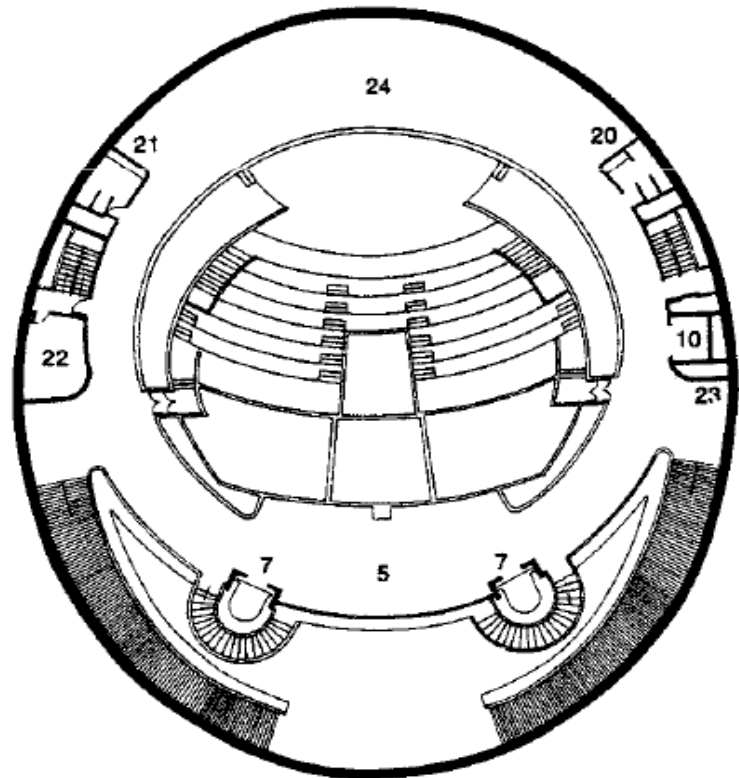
Mezzanine centro cultural alfa planta arquitectónica.
